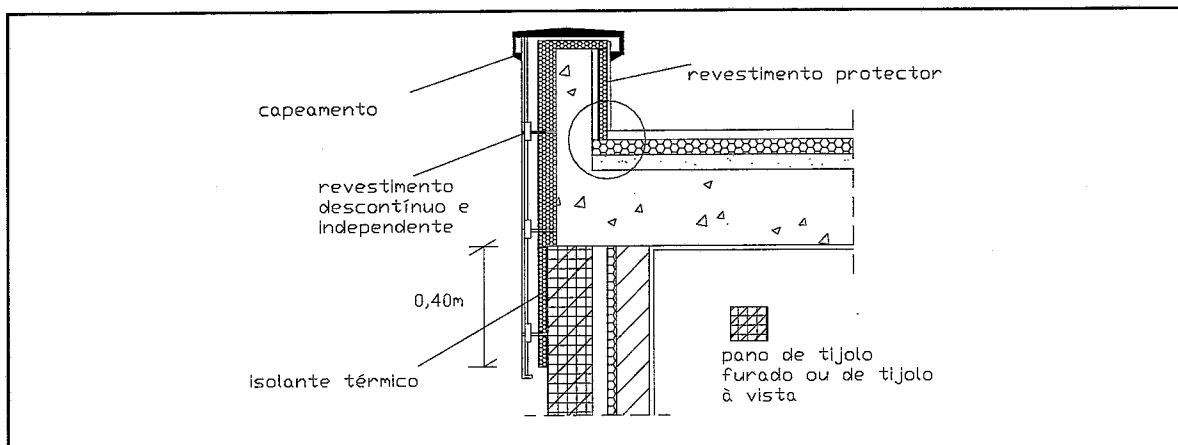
Pormenor da aplicação de revestimento descontínuo e independente sobre isolante térmico na ligação entre uma laje de cobertura e parede exterior
